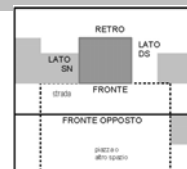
Il fronte fotografato prospetta su/ è adiacente a:
